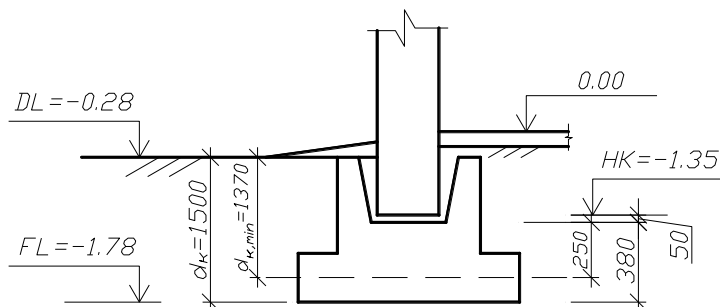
Схема к определению конструктивной глубины заложения подошвы фундамента
